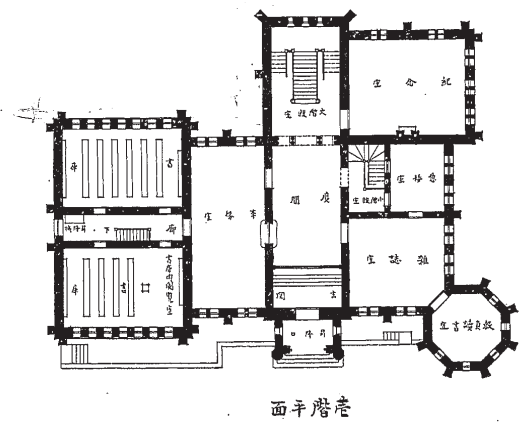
各階平面図 『慶應義塾創立五十年紀念圖書館紀要』記載
